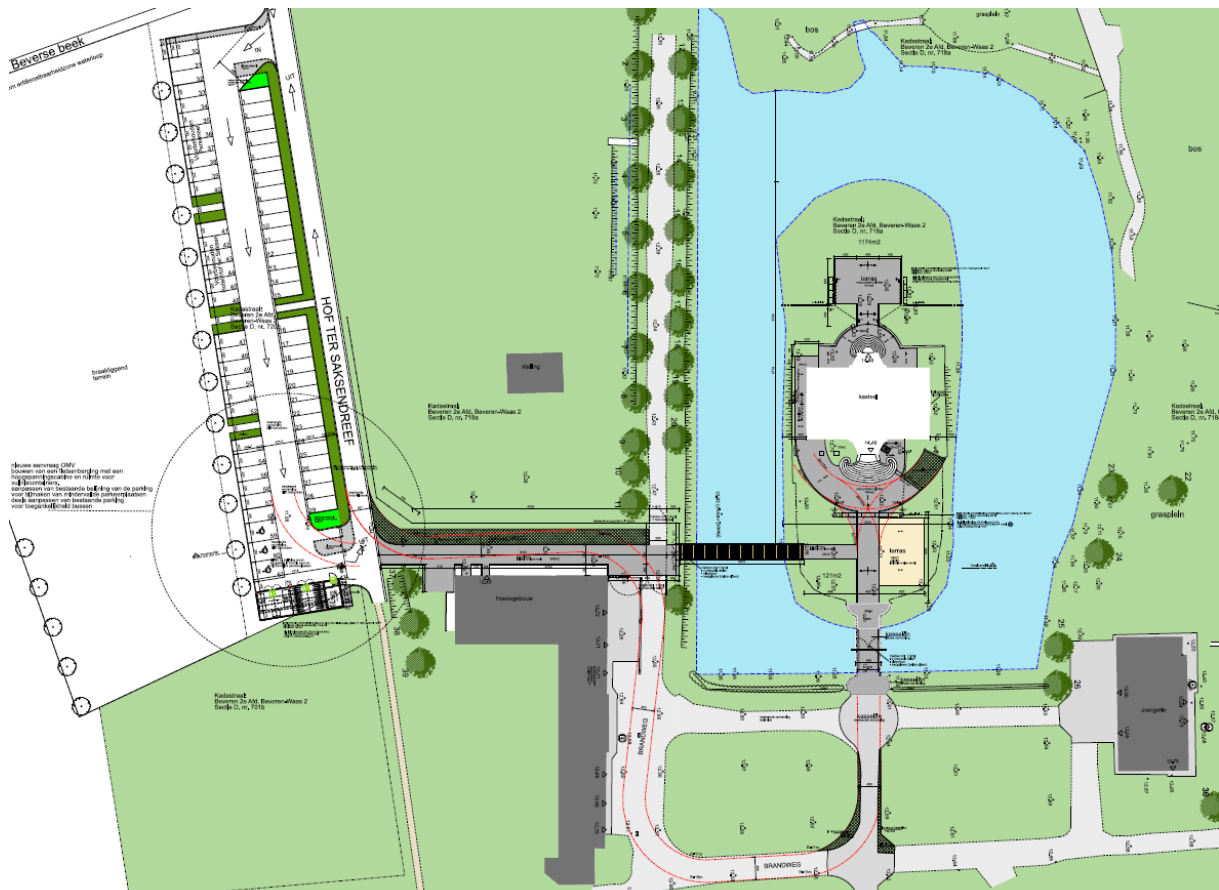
▲ Vergunde inplantingsplan van de parking en ontwerp brug en terras bij kasteel – bron: gemeente Beveren
